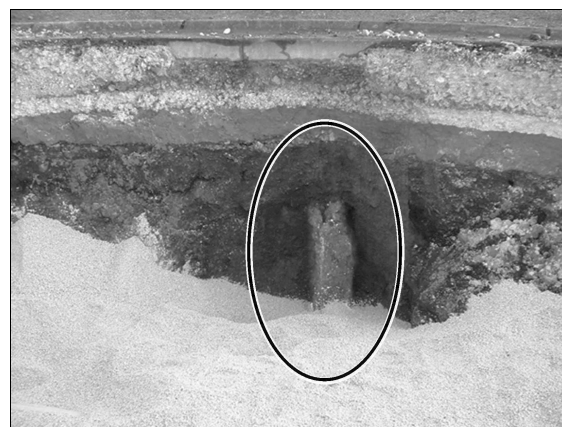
on distingue un pieu dans la terre argileuse du sous-sol, les couches supérieures, sablon, calcaire et enrobé constituant l'ancienne chaussée. La couche claire du premier plan est le calcaire fin du remblai de tranchée
